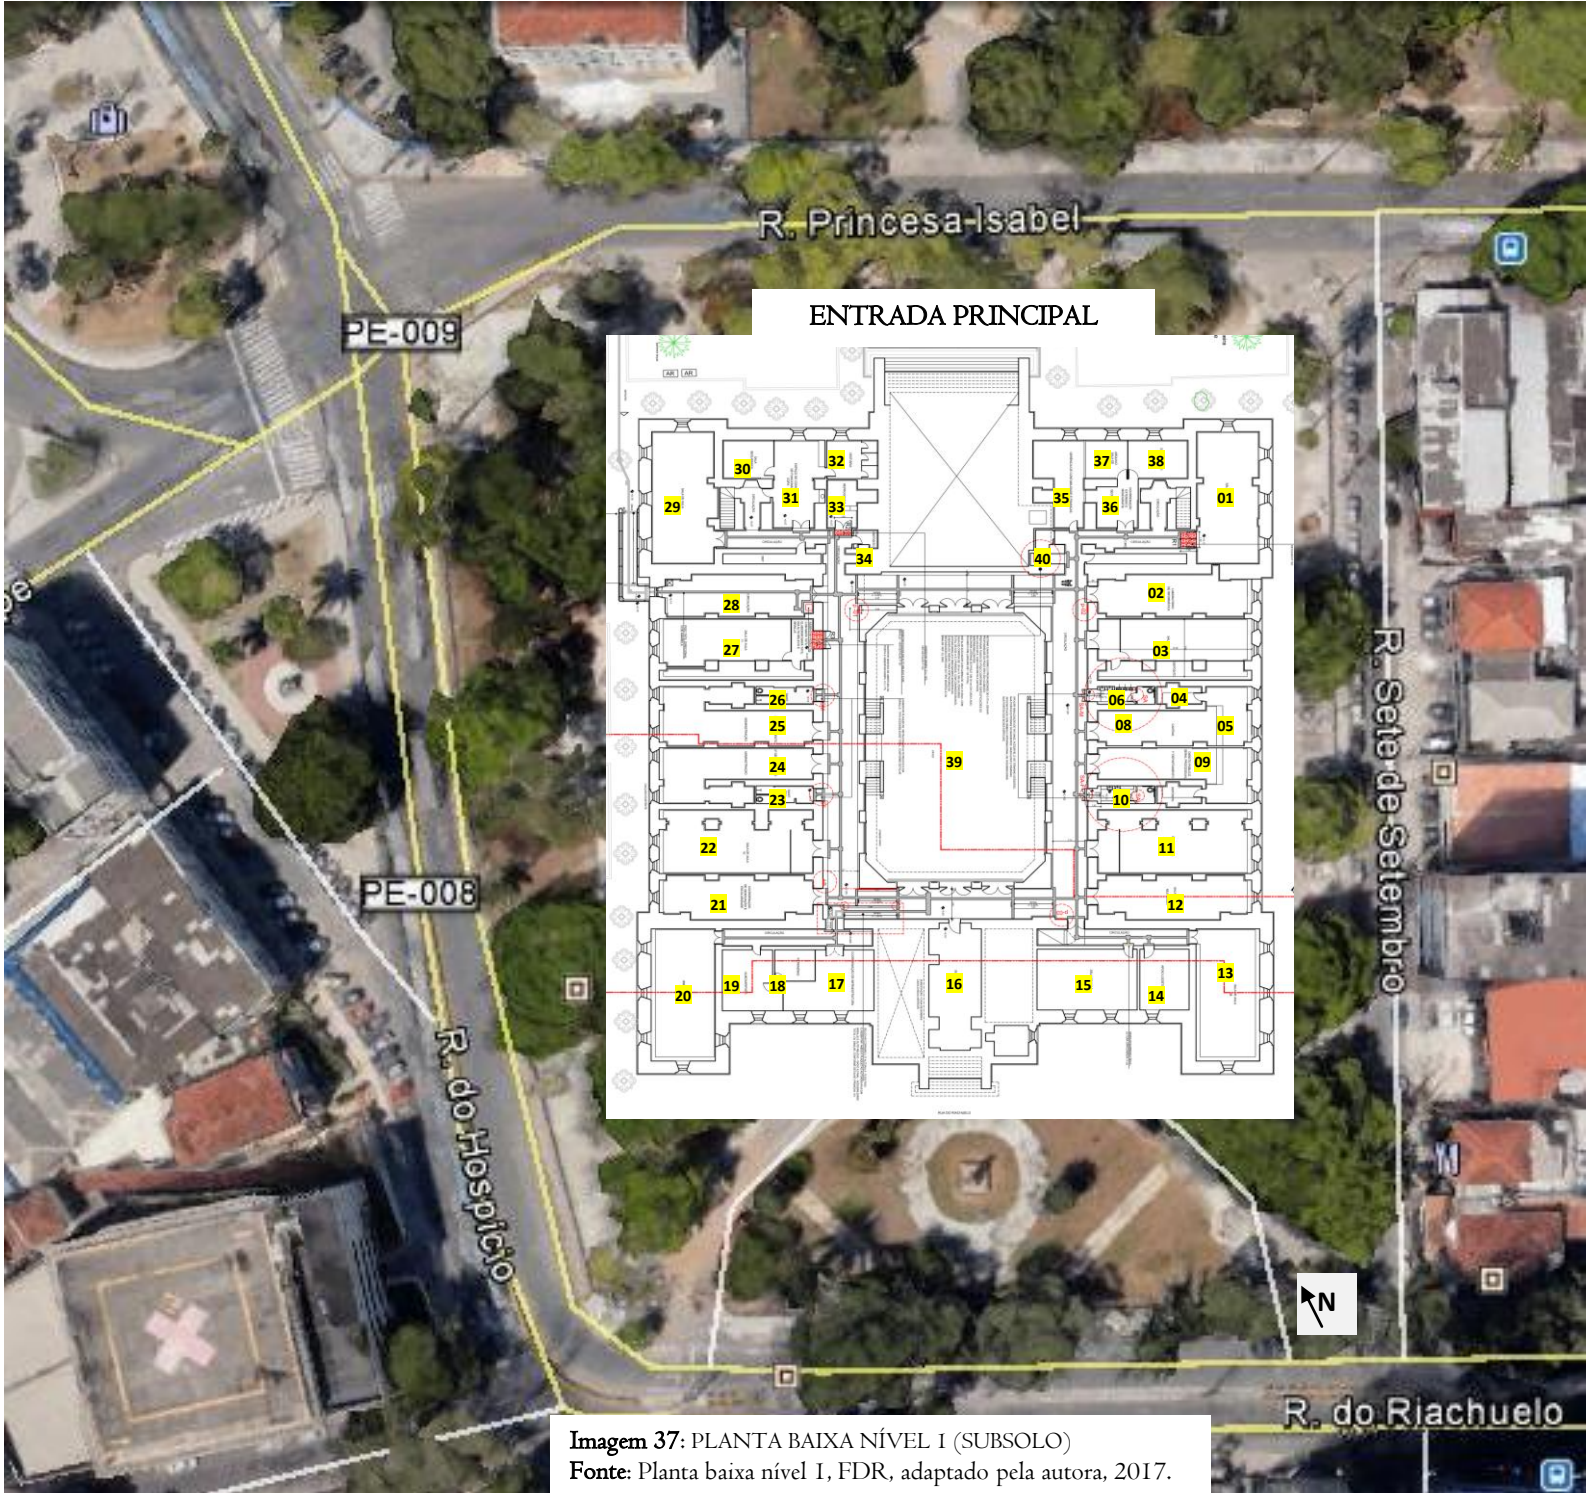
PLANTA BAIXA NÍVEL I (SUBSOLO)
